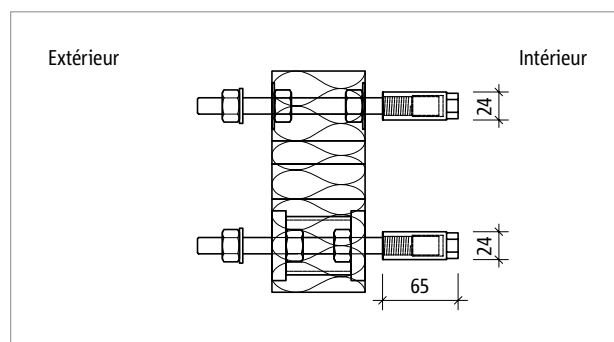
Schöck Isokorb® T type S avec écrous borgnes : coupe du produit
